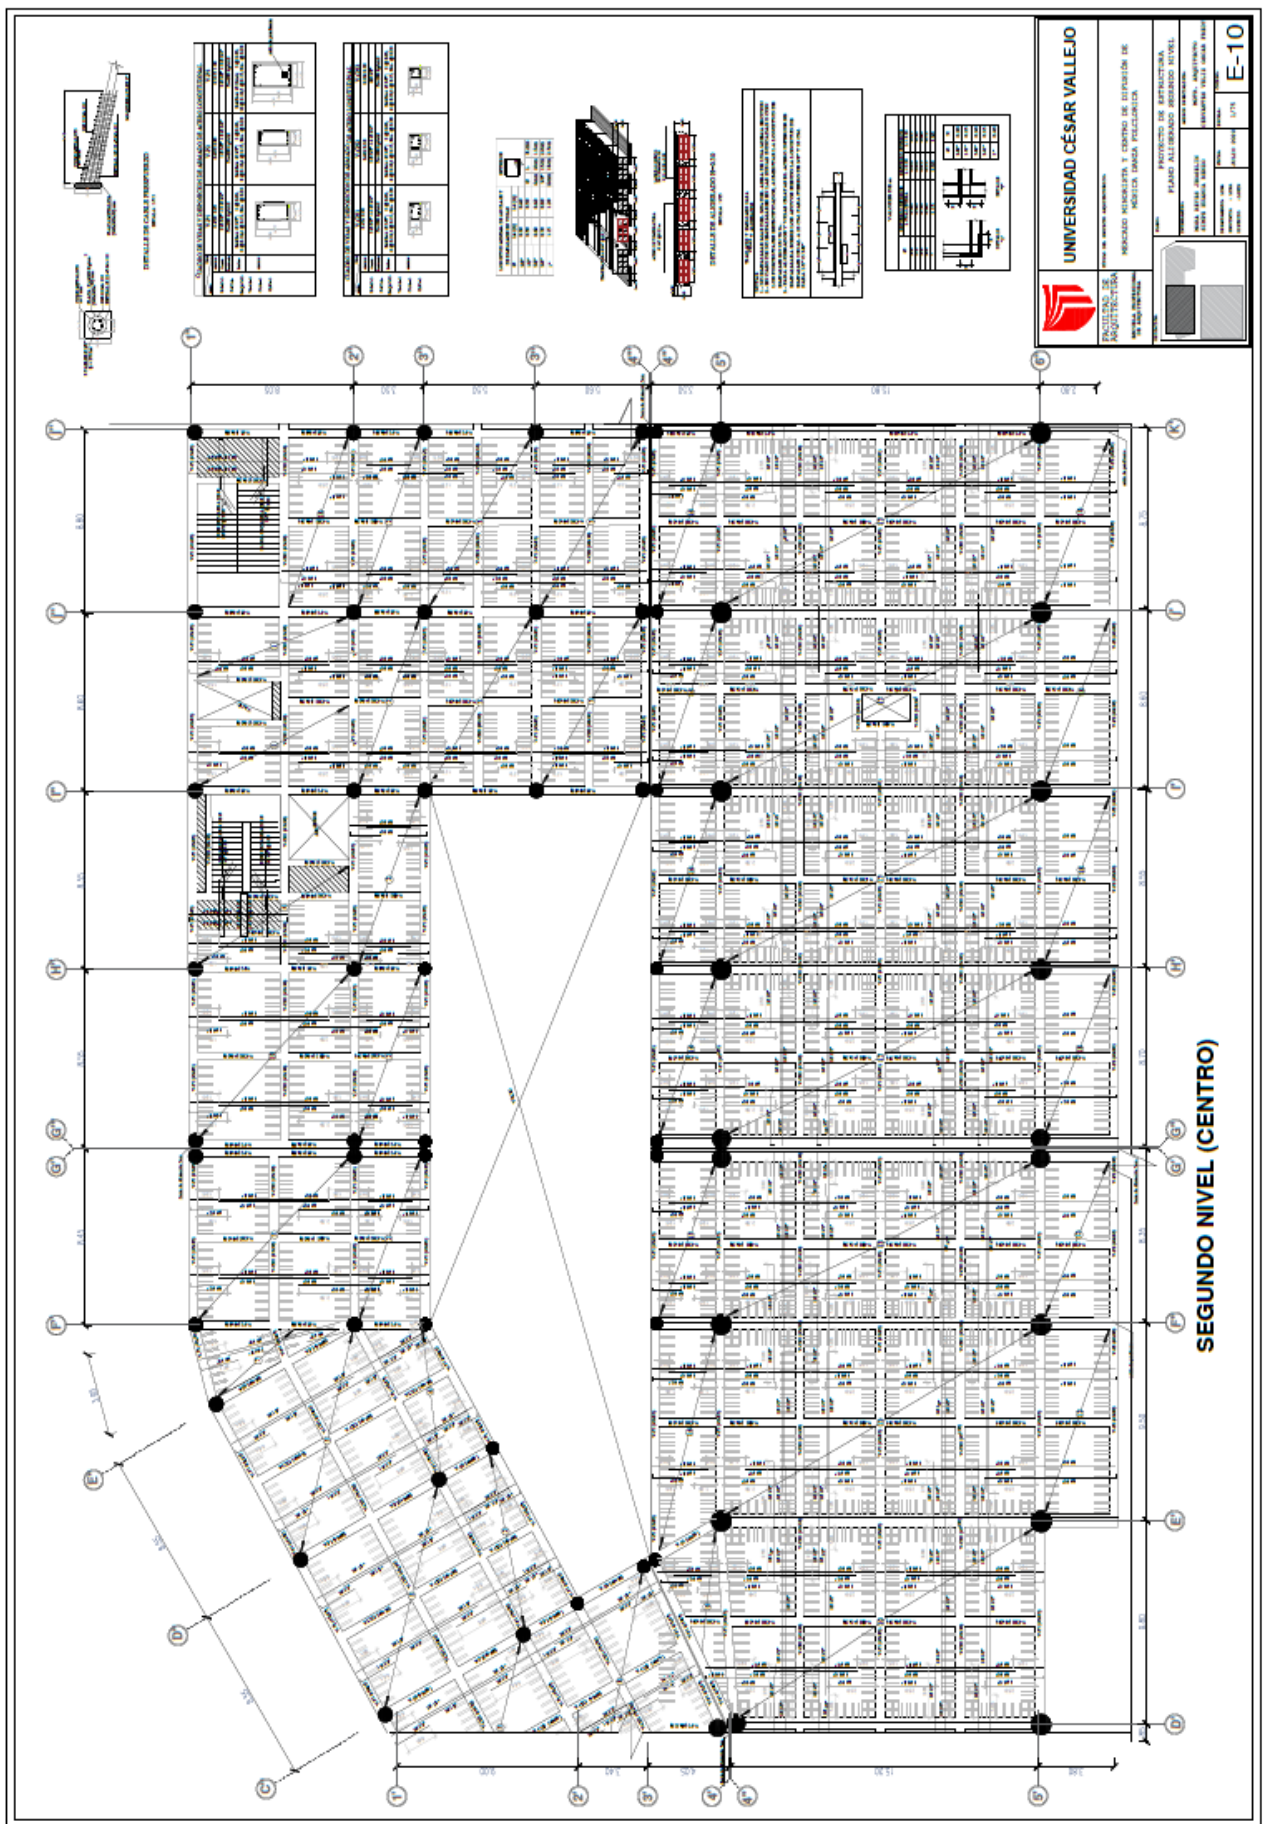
Plano de Estructura Segundo Nivel Centro - Proyecto
